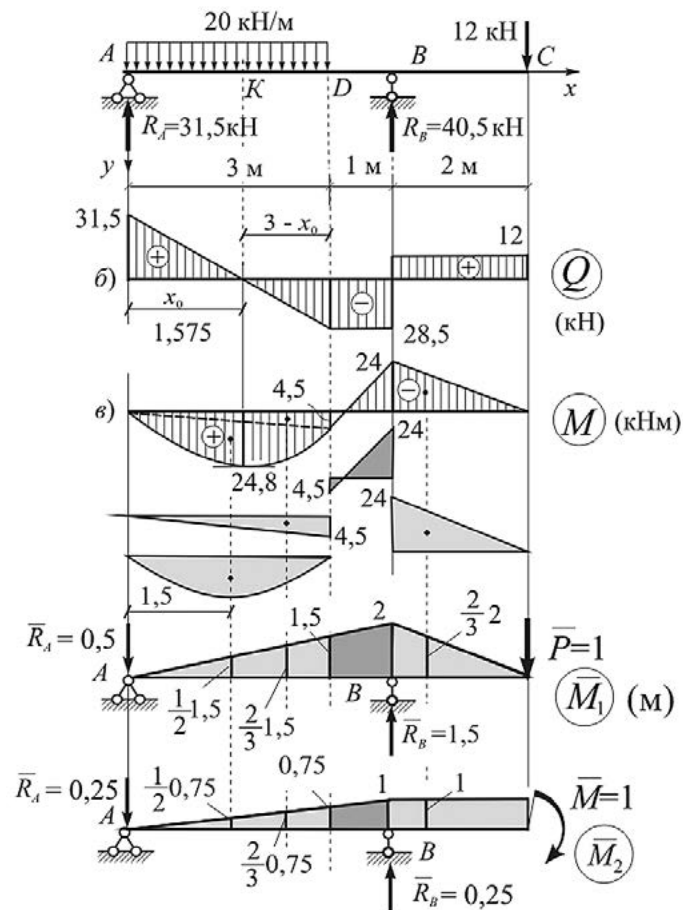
Схема балки и эпюры к зад. 6.2.1
